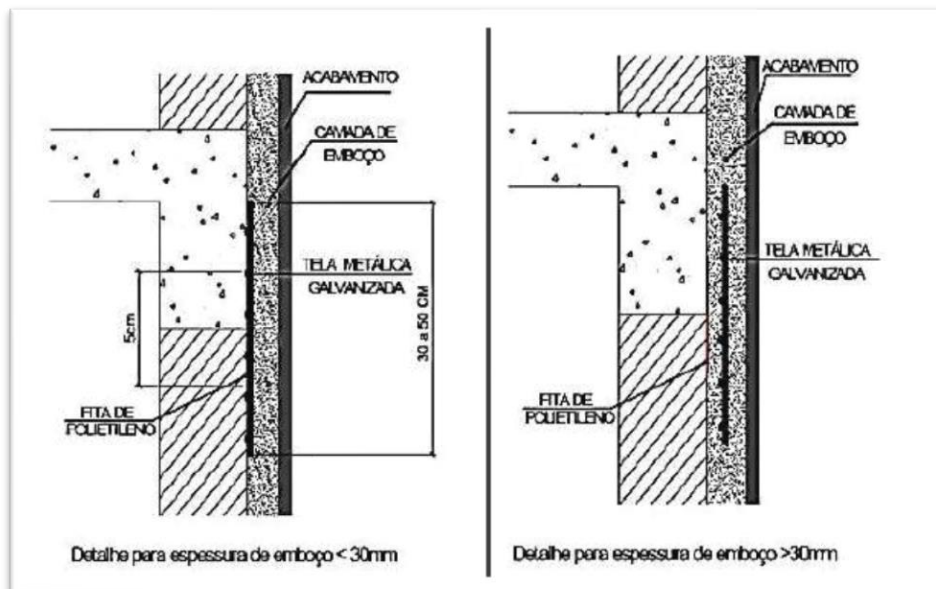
Posicionamento das telas metálica na camada de recuperação.
